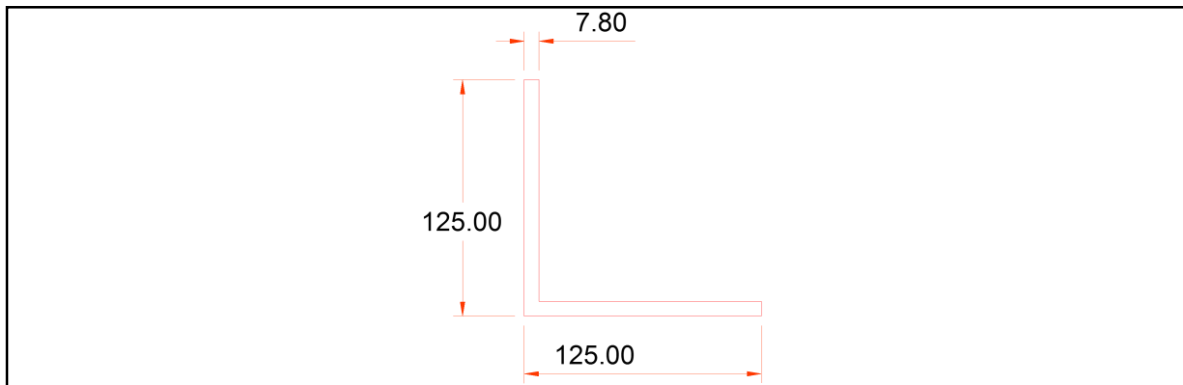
Dimensiones de perfil metálico L5x5x5/16 (en mm)
